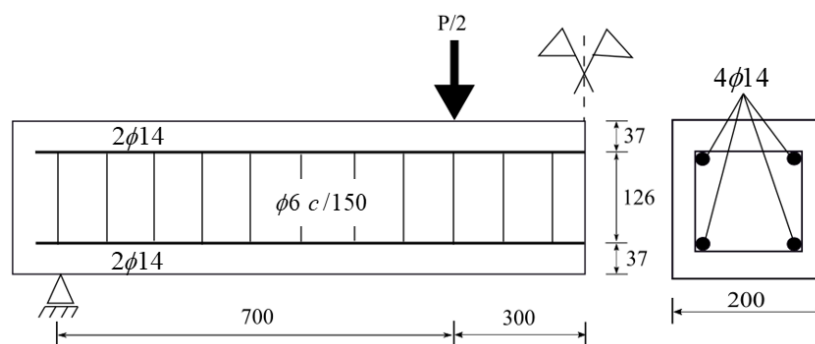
Elemento estrutural analisado (dimensões em mm) [8]
